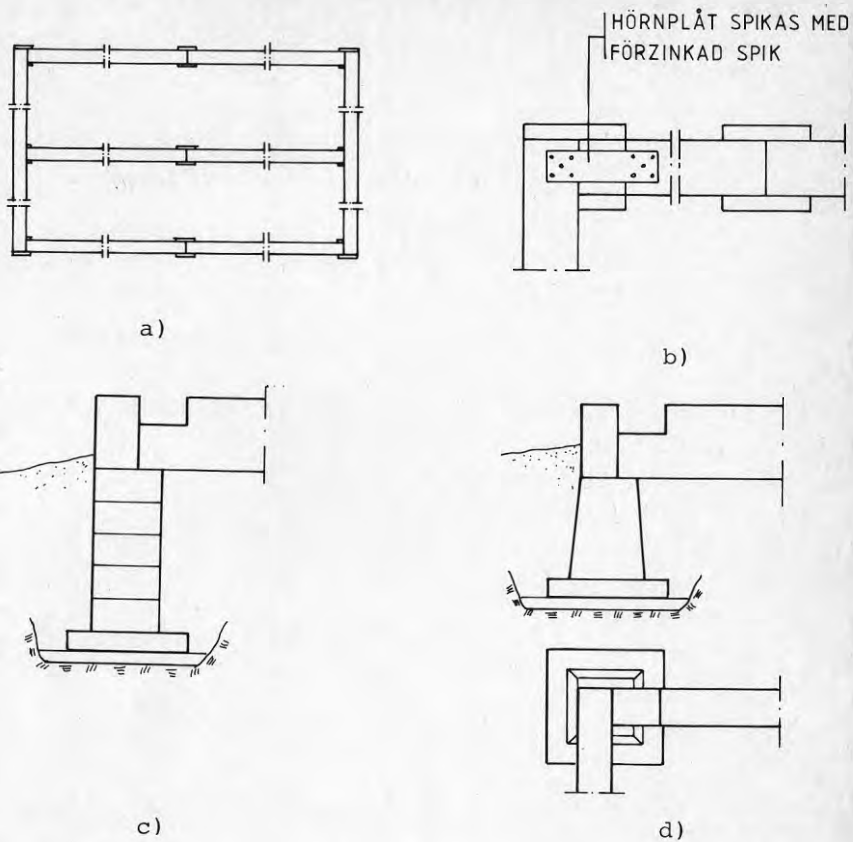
Grundkonstruktionen består av stödplattor och grundbalkar, den s k Tjälldänggrunden. Uppskattad kostnadsbesparing är 40-90 kr per löpmeter "grundmur" jämfört med fasadgrundmur bestående av gjuten sula 500x200 mm och 4 skift-200 mm betonghålblock.
